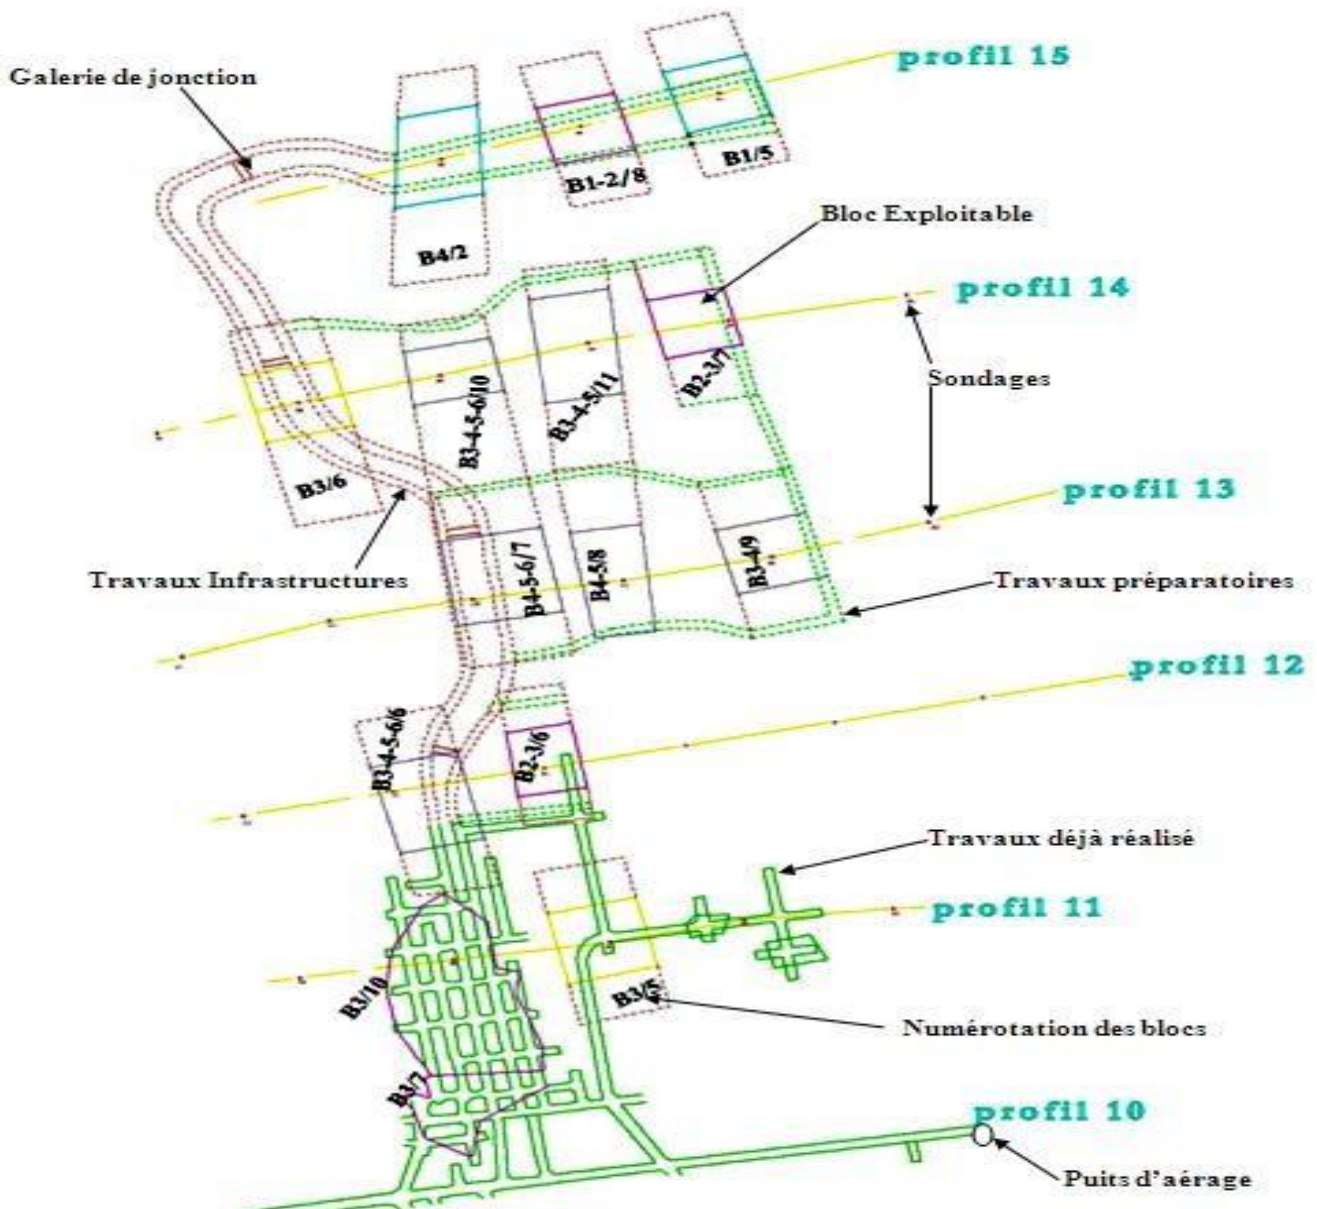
Plan de travaux préparatoires et infrastructures [15].
